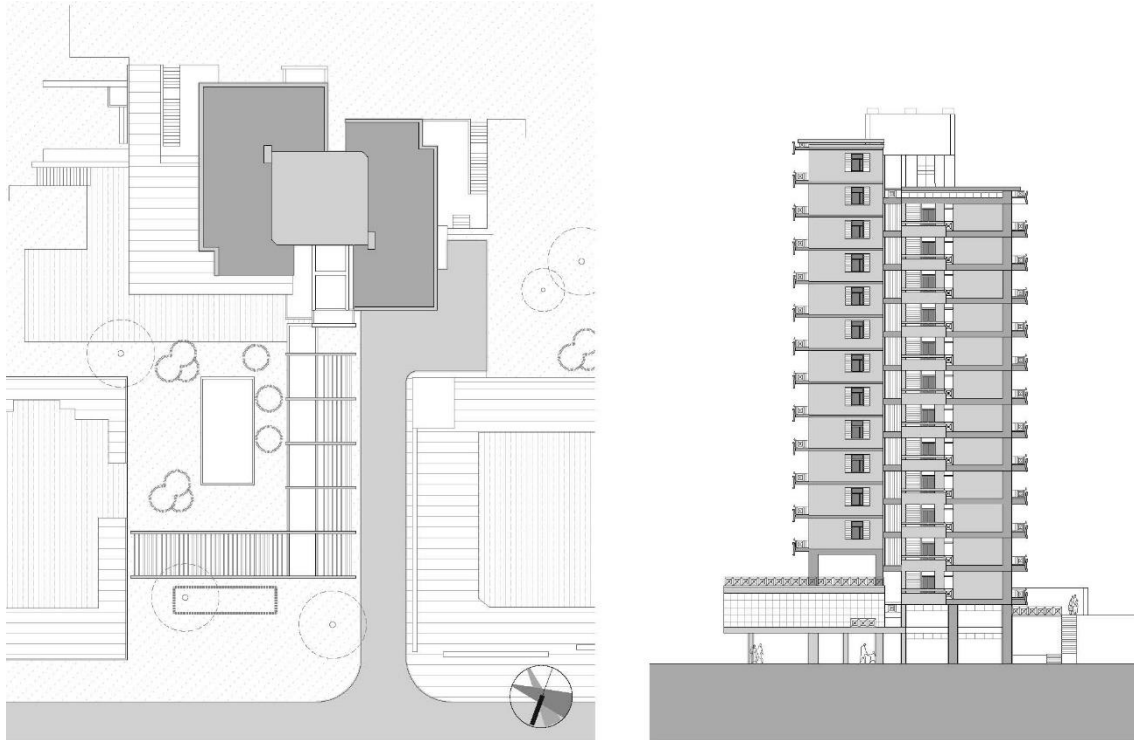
Torre Leal Senado de Ramalho (1962-1966), Macau: Planta de implantação; Alçado Norte
